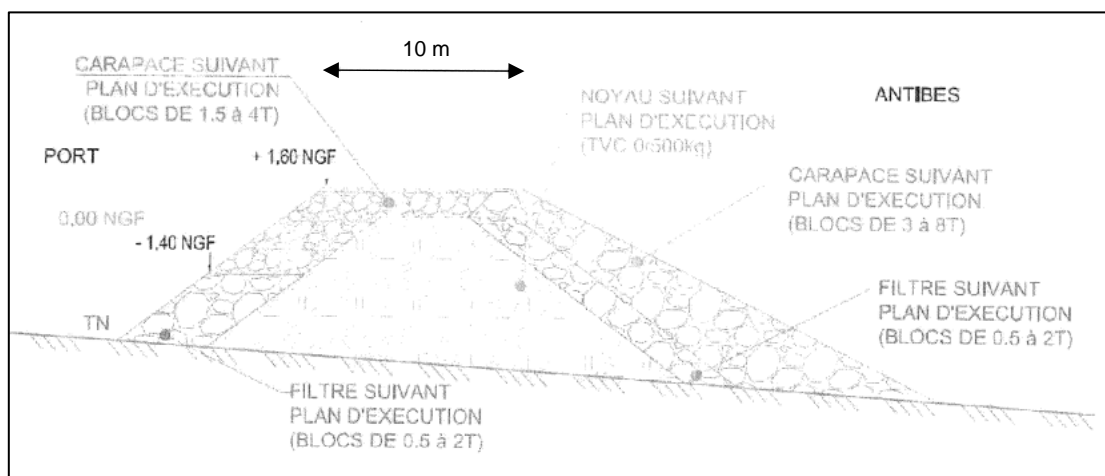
Coupe type de la contre-jetée du port construite en 1970
